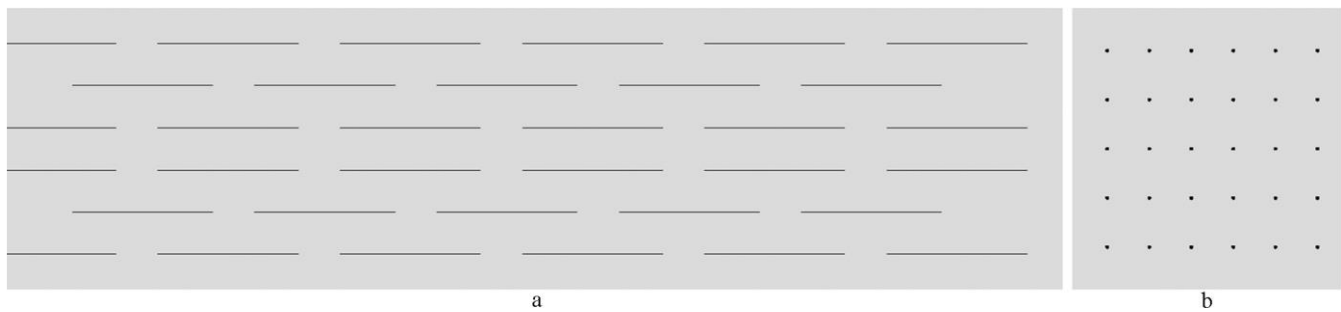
Disposición de las fibras en las probetas de concreto: (a) vista en sección de planta, y (b) vista en sección transversal.
